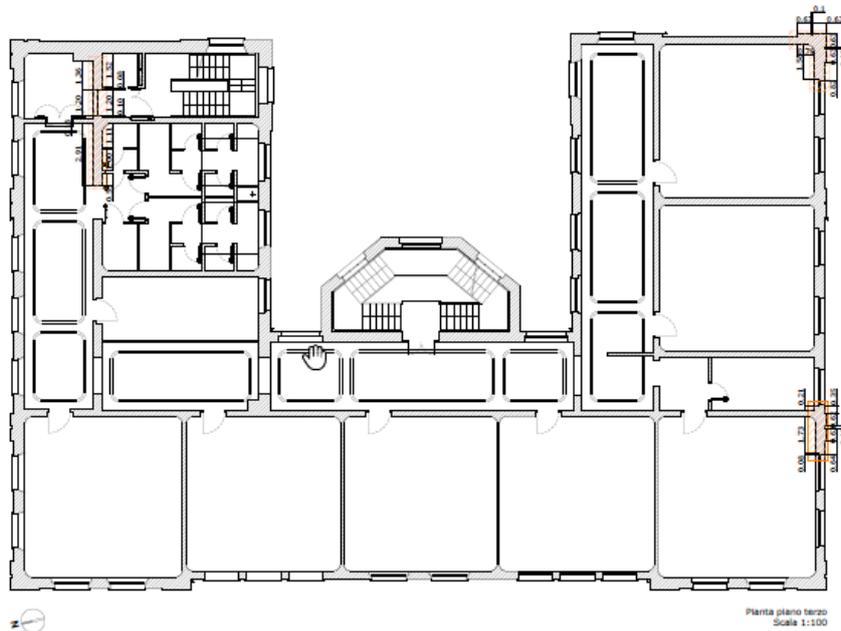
Pianta piano Terzo con indicazione delle zone di intervento
